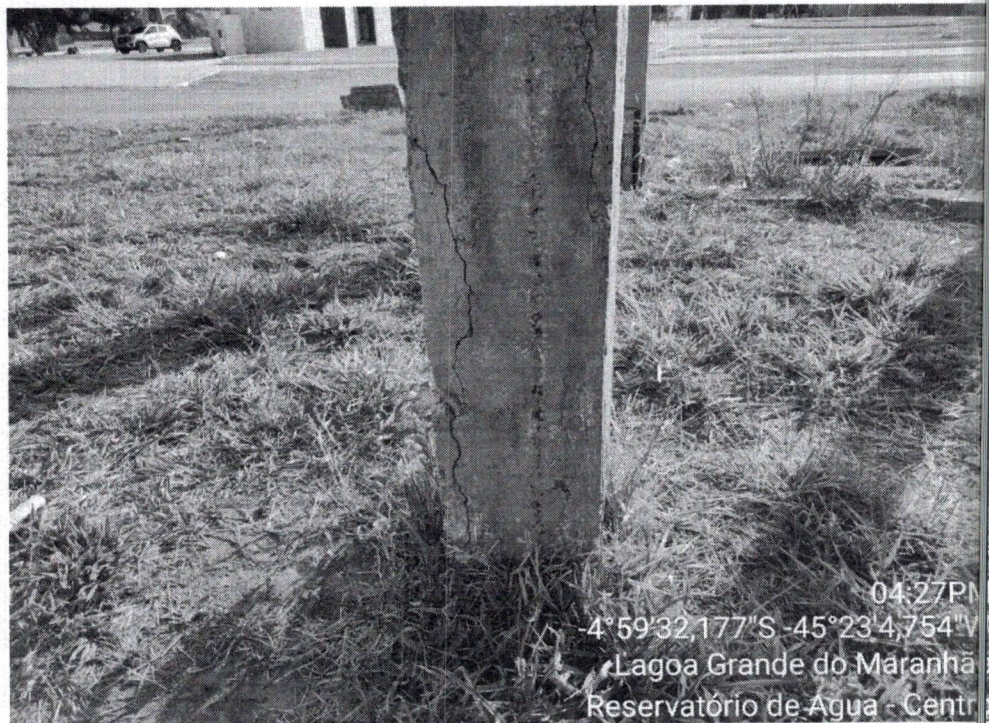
R. Situação dos Pilares, trincas, exposição das armaduras.
